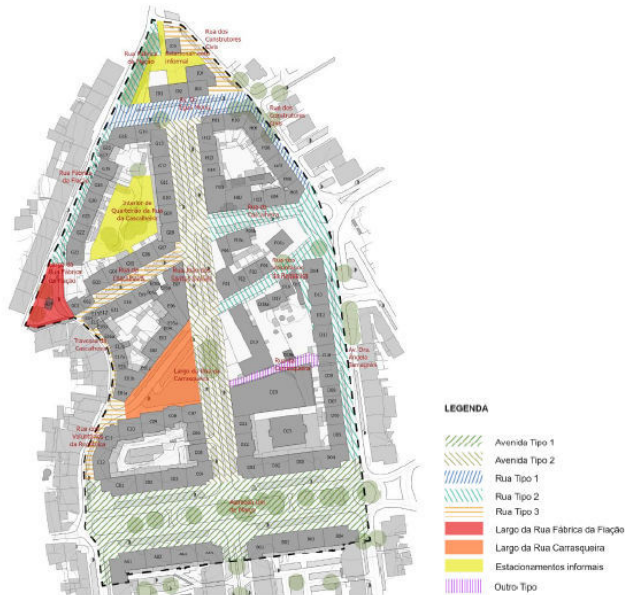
Distinção das tipologias de perfil de arruamento no Plano.
